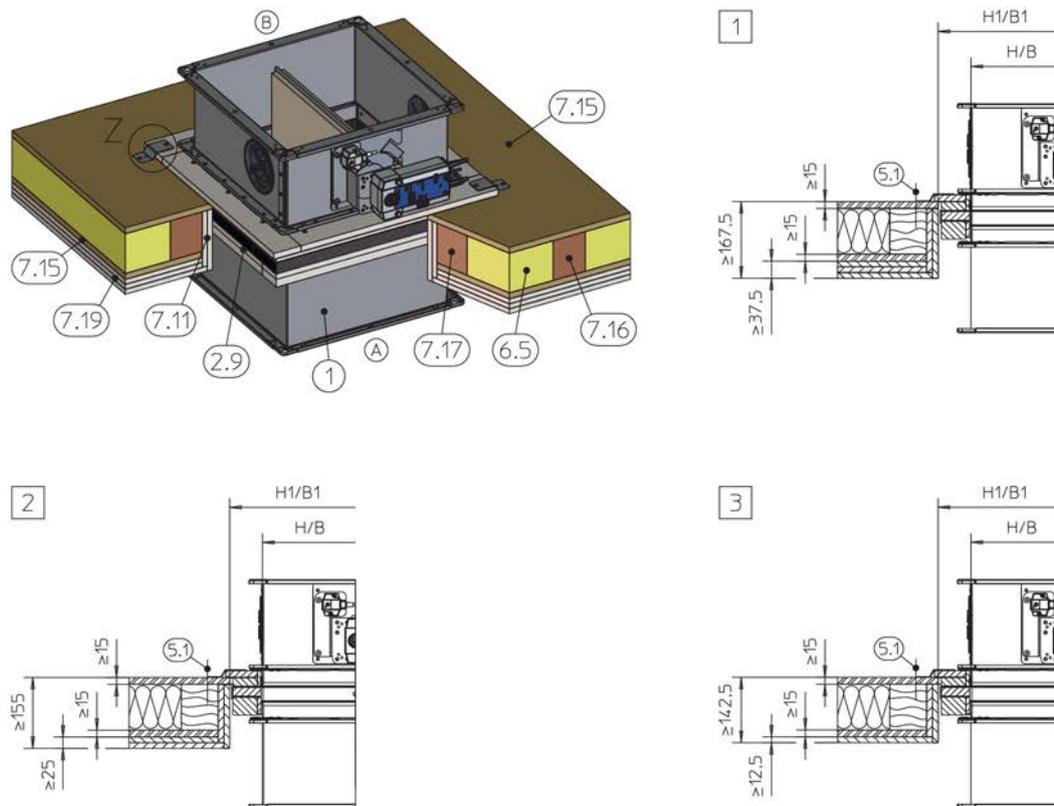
Instalación con mortero en vigas de madera/vigas de madera laminada, suspendida (representada en la ilustración, bajo consulta también para otros acabados de techo)
